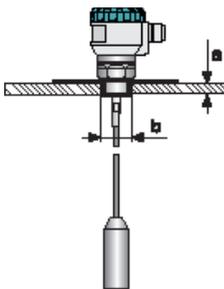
Installation des Füllstandmessers in der Decke eines Betonsilos
